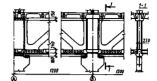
Конструкция железобетонных перекрытий, опирающияся на фермы-ригели (пример)
